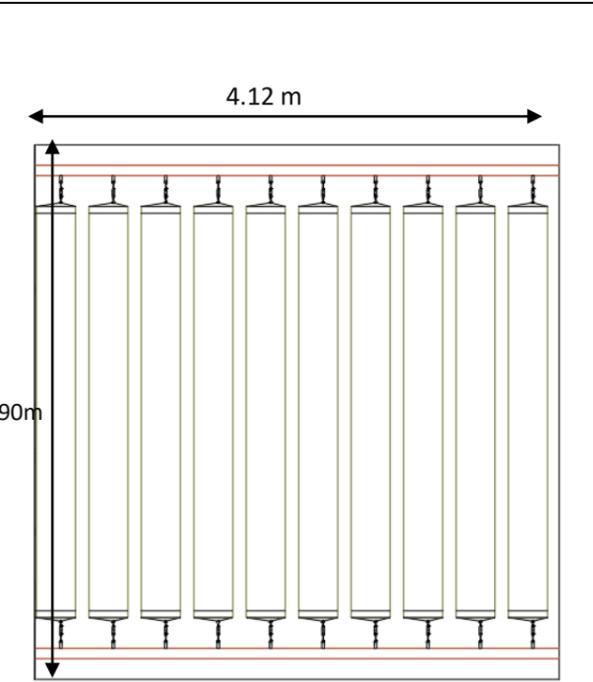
Vue en plan de la pergola,soucre : Les Auteurs.
